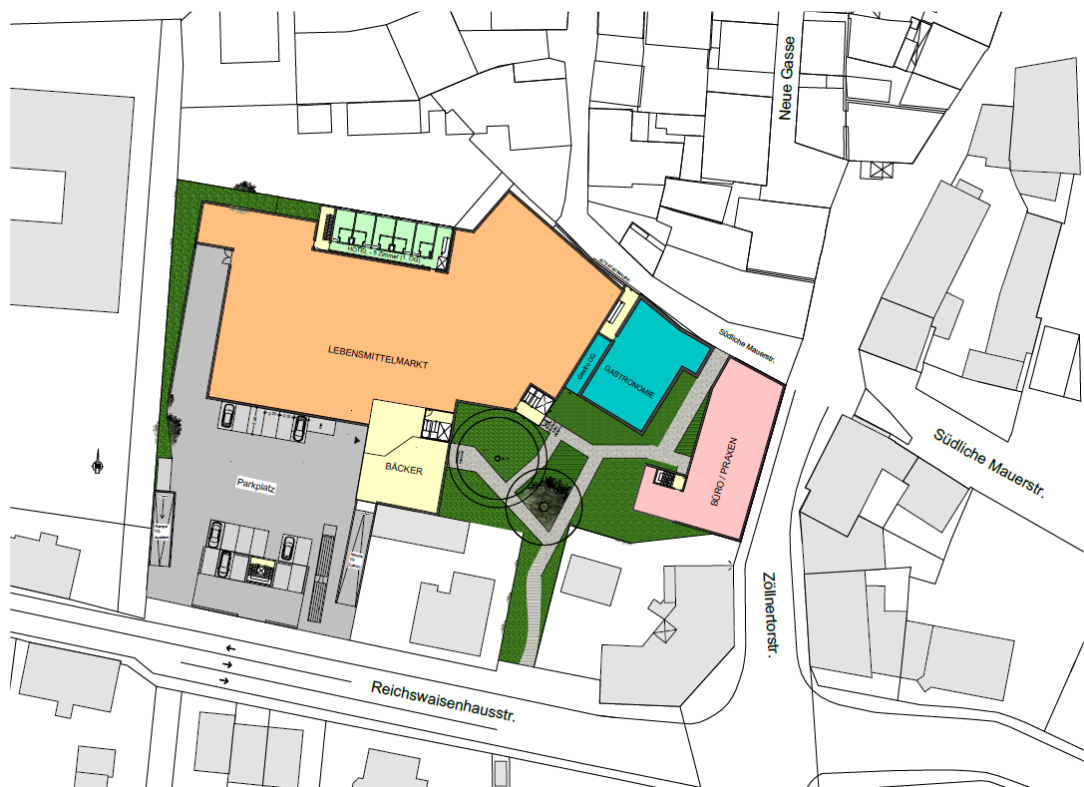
Entwurf des vorhabenbezogenen Lageplans (Nutzungen im 1. Obergeschoss, Stand 09/2023)
